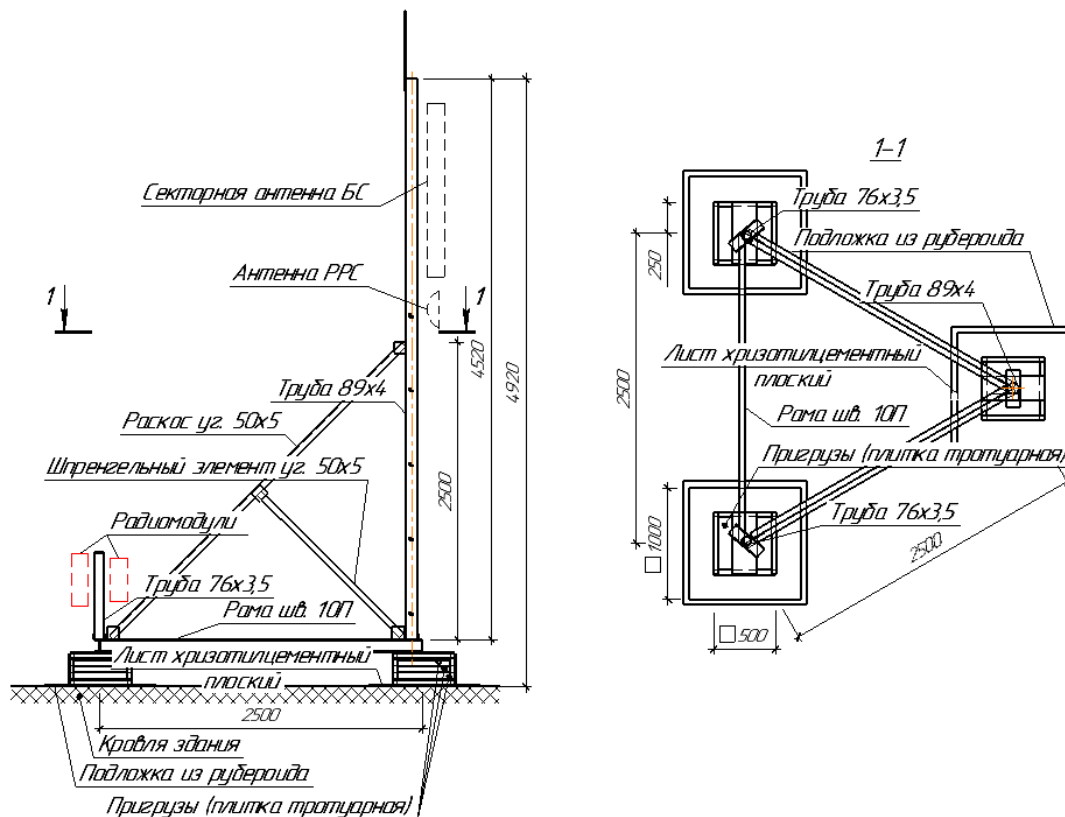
Устройство трубостойки на разгрузочной раме с пригрузами для размещения на кровле здания
